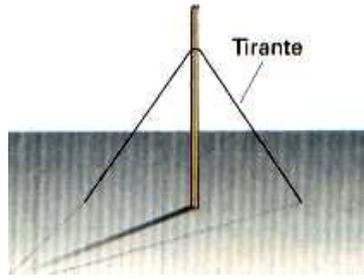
Tirantes (www.ConstruAprende.com)
